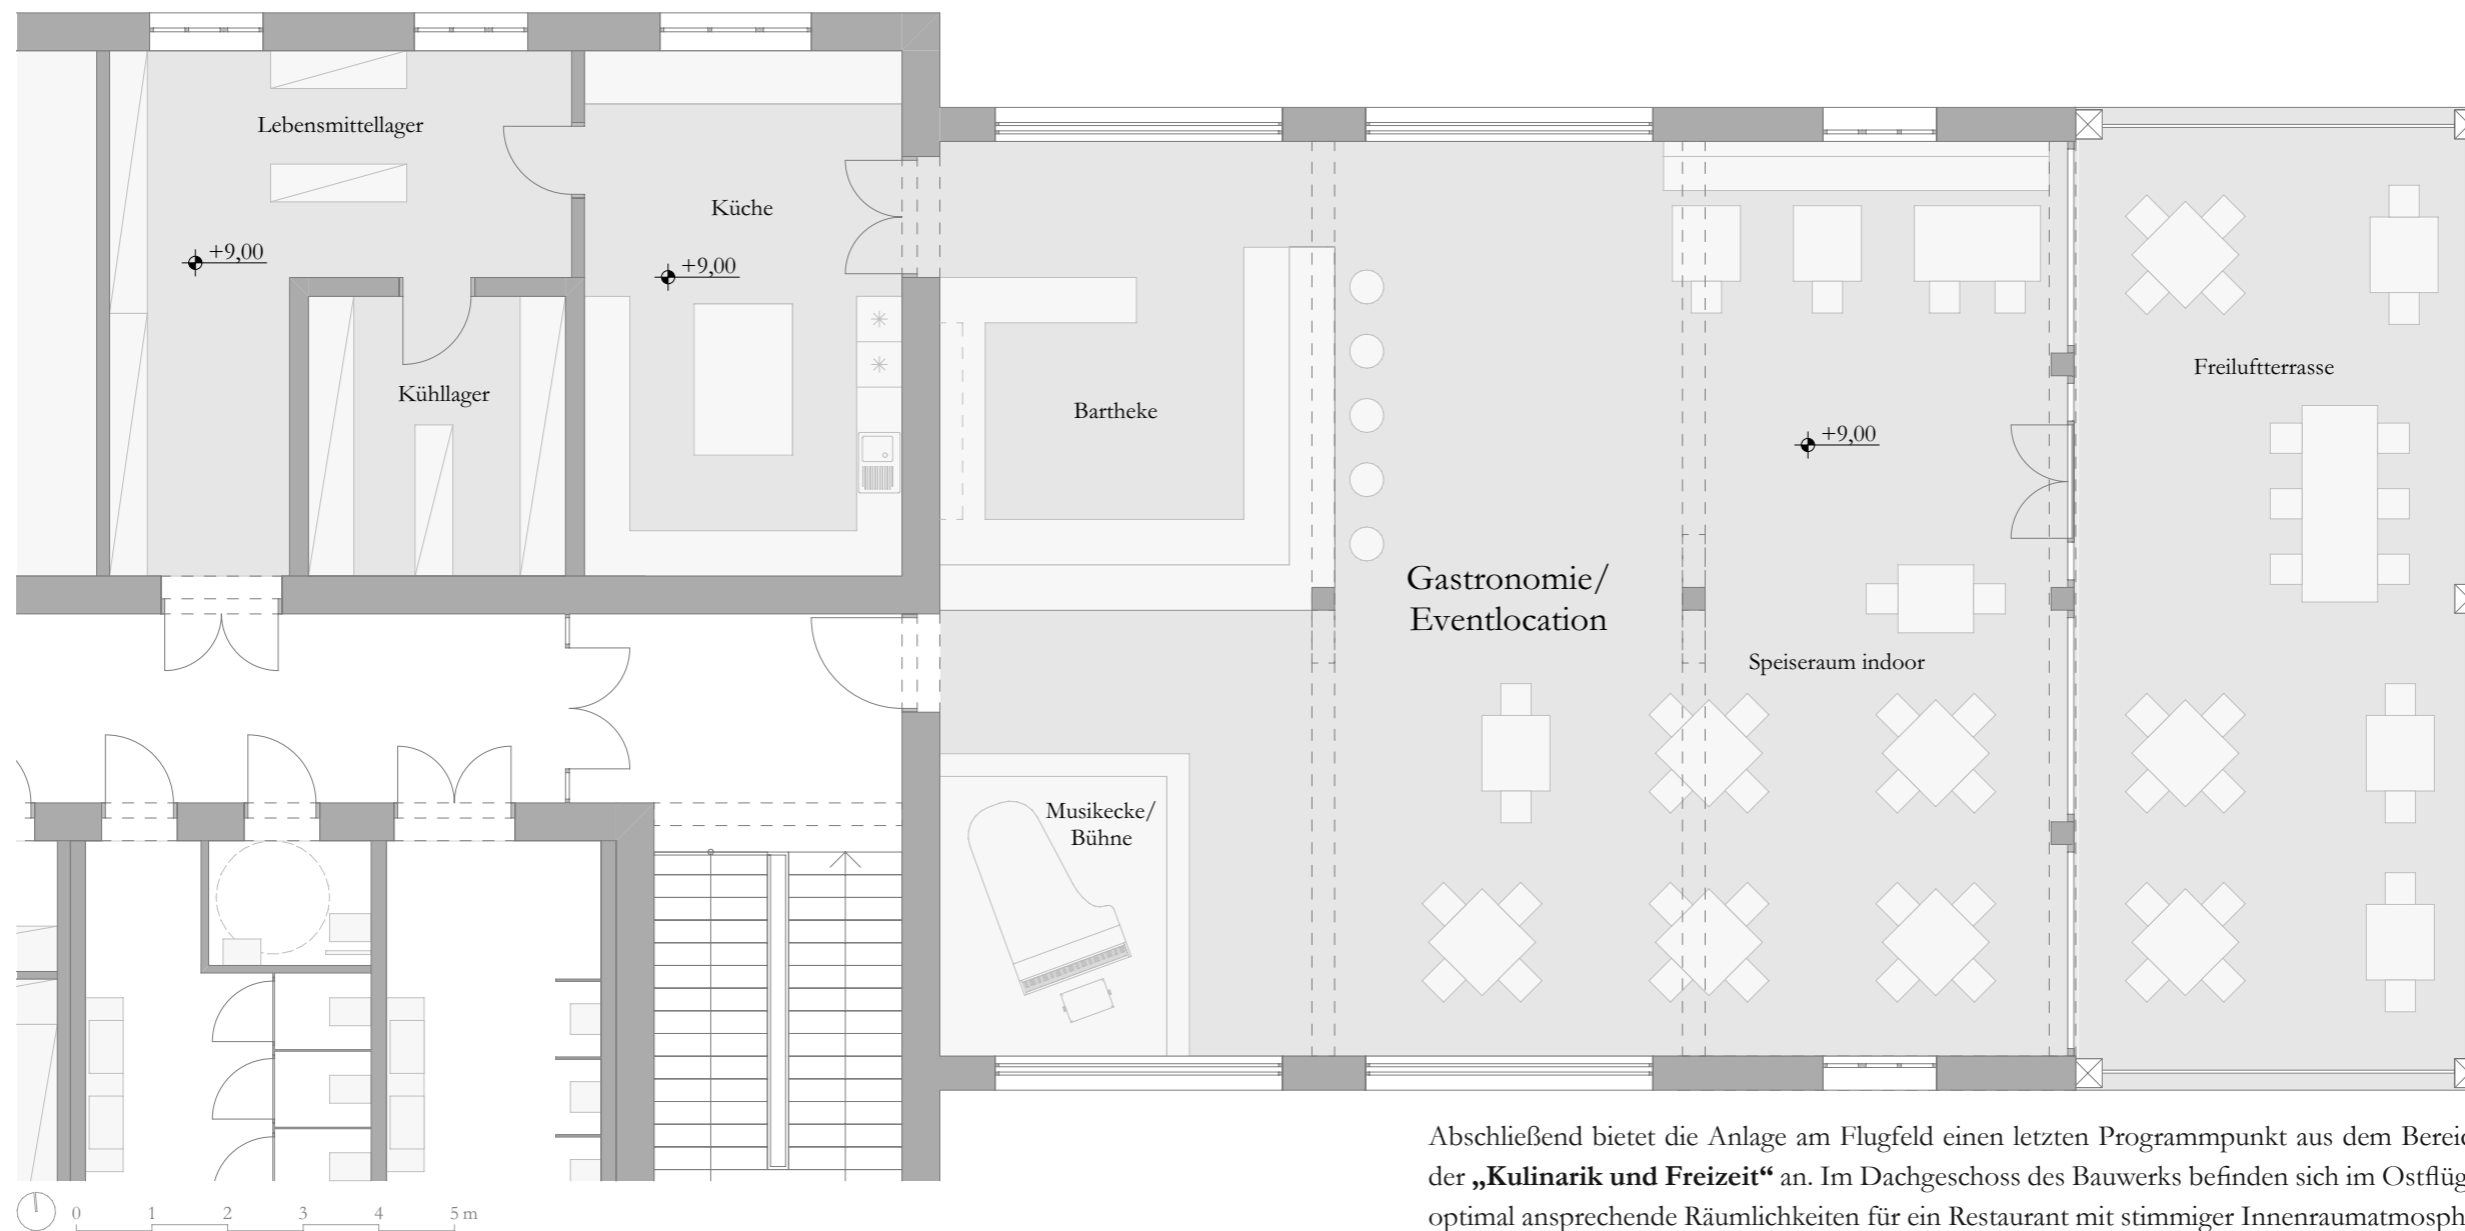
Grundriss Dachgeschoss (Gastronomie/Eventlocation) M 1:100
